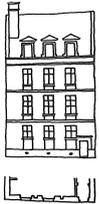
Planta parcial e Corte da rua da 2.ª distribuição da Praça VI
